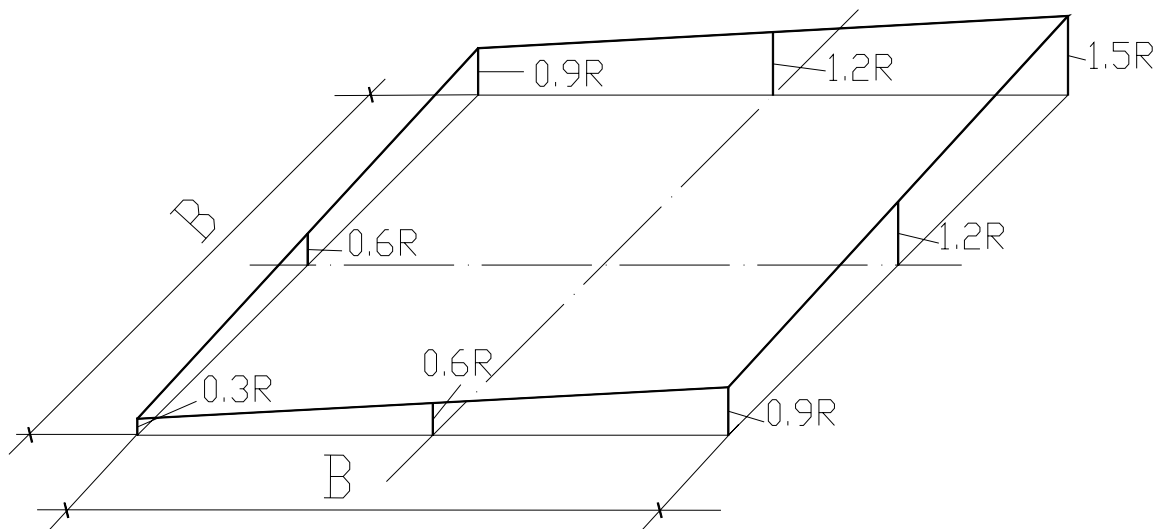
Нормируемое распределение напряжений под подошвой фундамента
